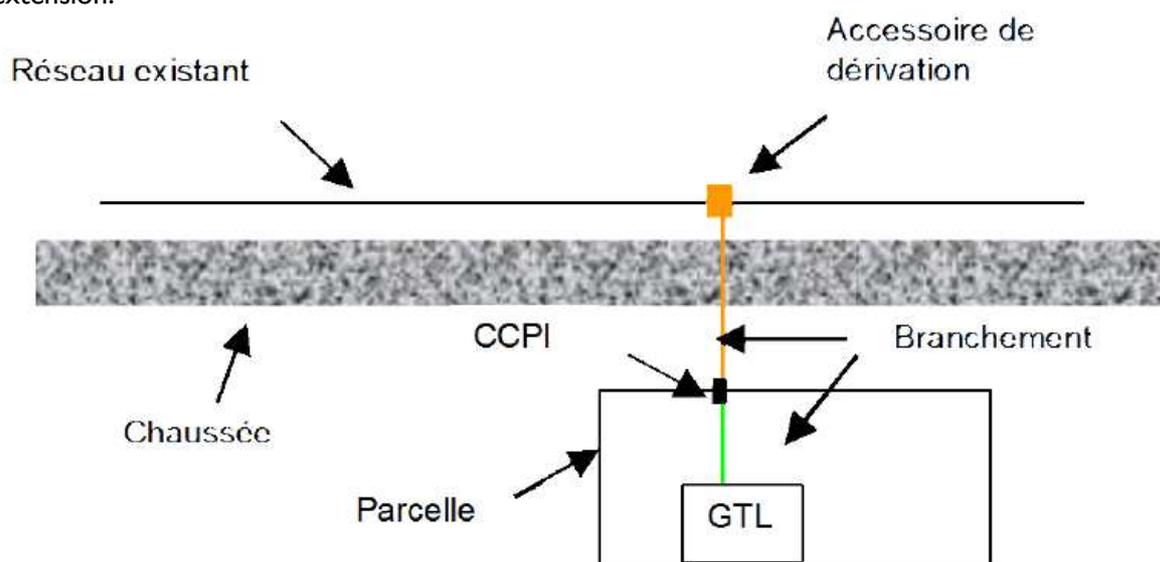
Raccordement individuel BT \leq 36 kVA avec traversée de chaussée
